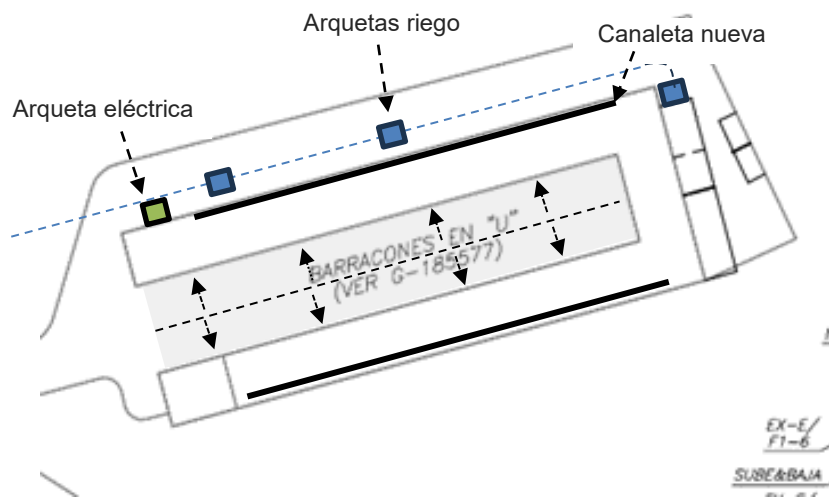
Situación arquetas a mantener y nueva solera de hormigón
